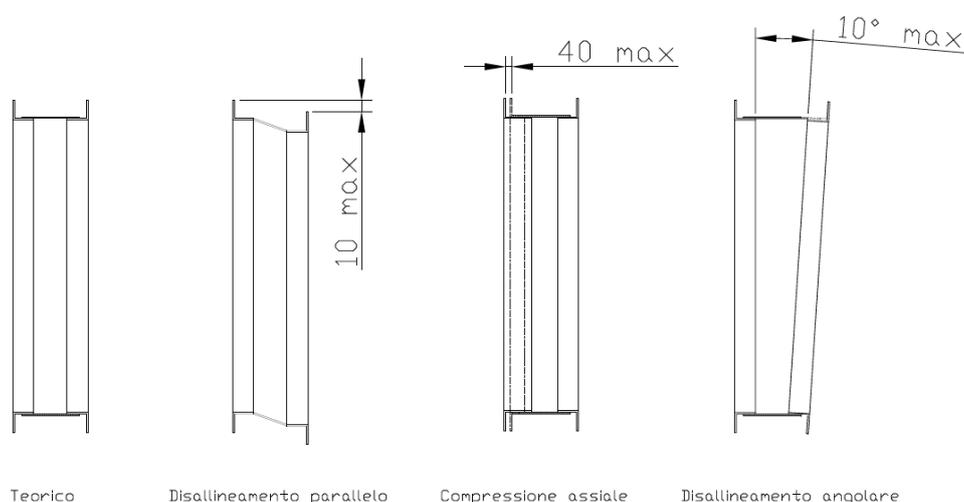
Tolleranze di montaggio dei giunti flessibili
